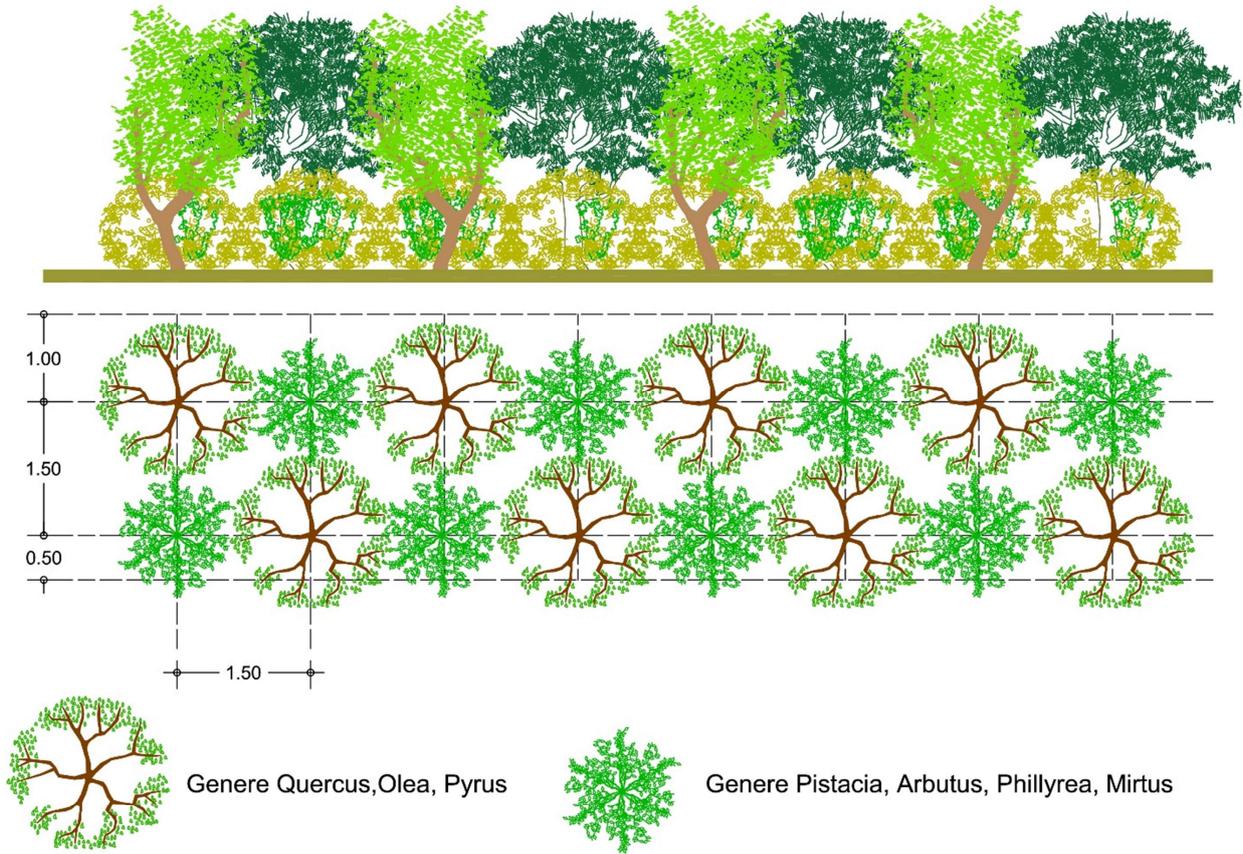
Dettaglio planimetrico della fascia verde di mitigazione
